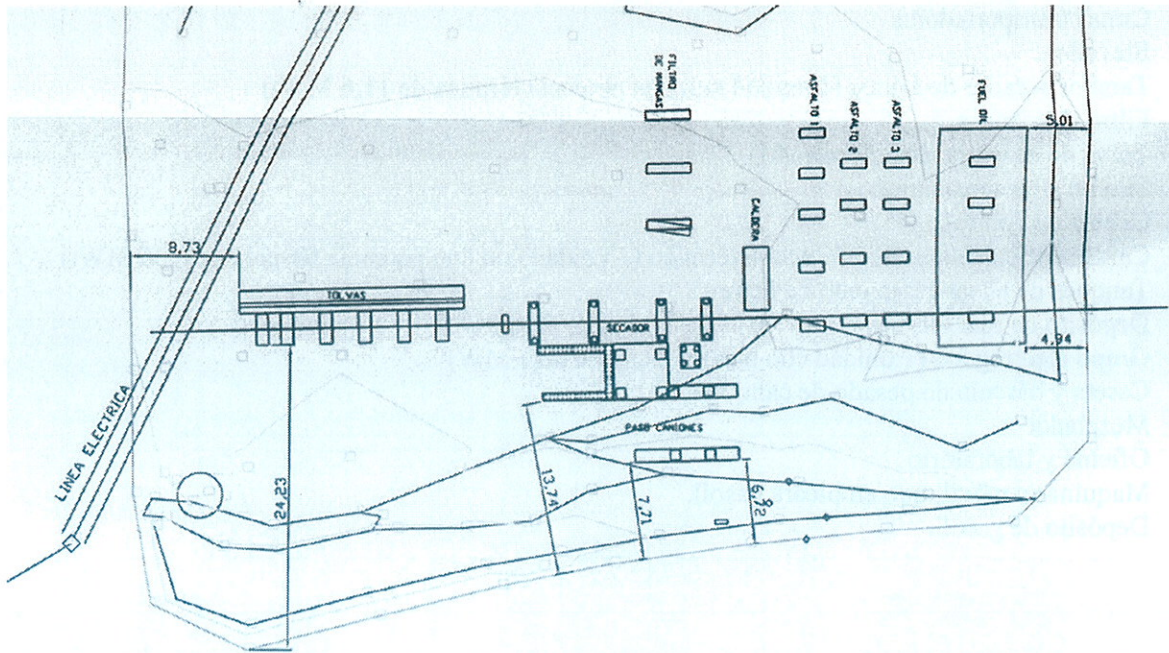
Plano en planta de instalaciones, infraestructuras y equipos.
